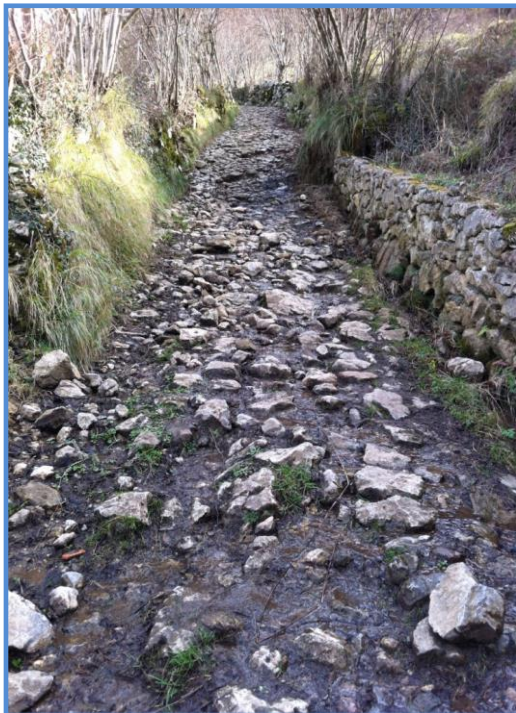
Empedrado original de la calzada en el descenso hacia el Norte desde la Canal Seca.
